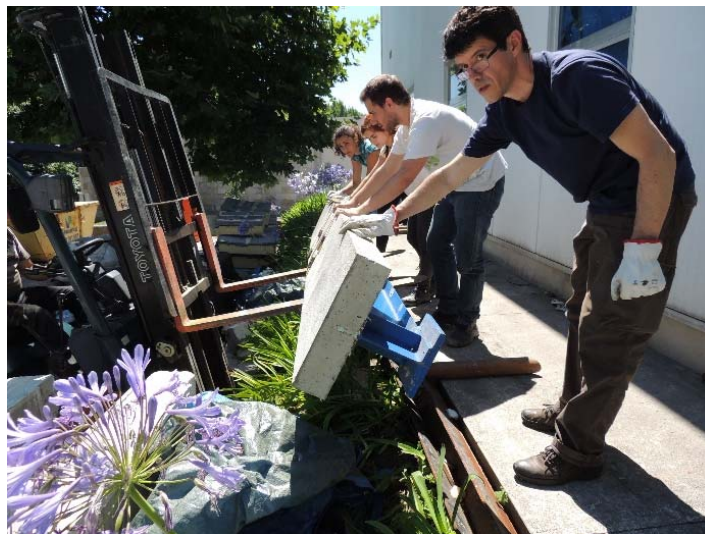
Descofragem e transporte da viga para o local de ensaio
